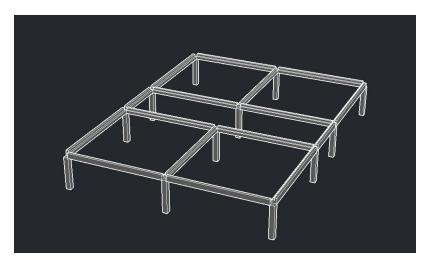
Simulación 3D de pilares prefabricados unidos con vigas prefabricadas. Fuente: Elaboración propia.
